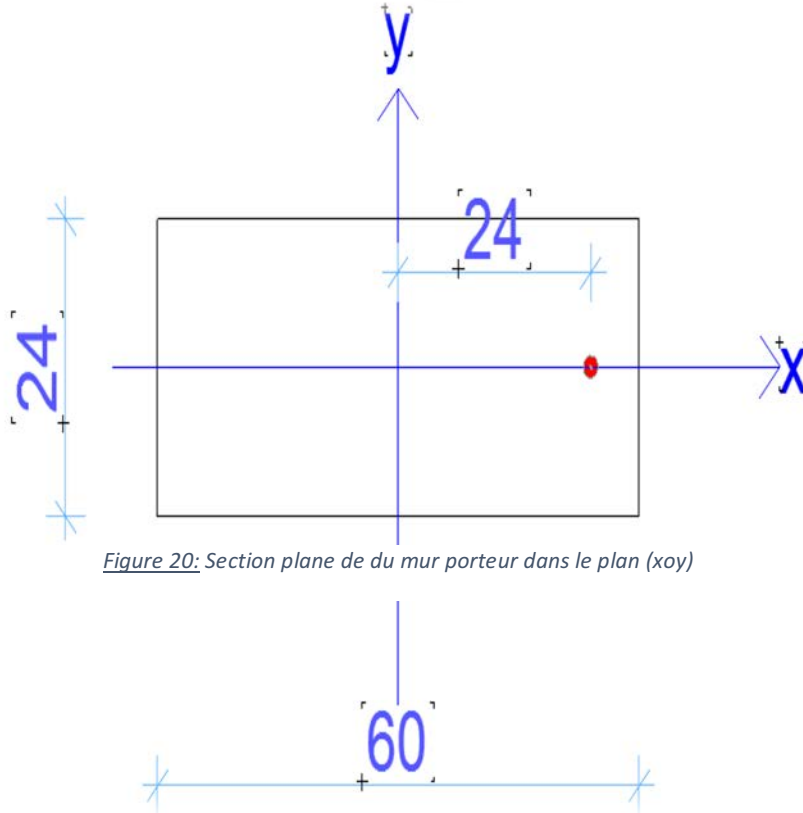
Section plane de du mur porteur dans le plan (xoy)
